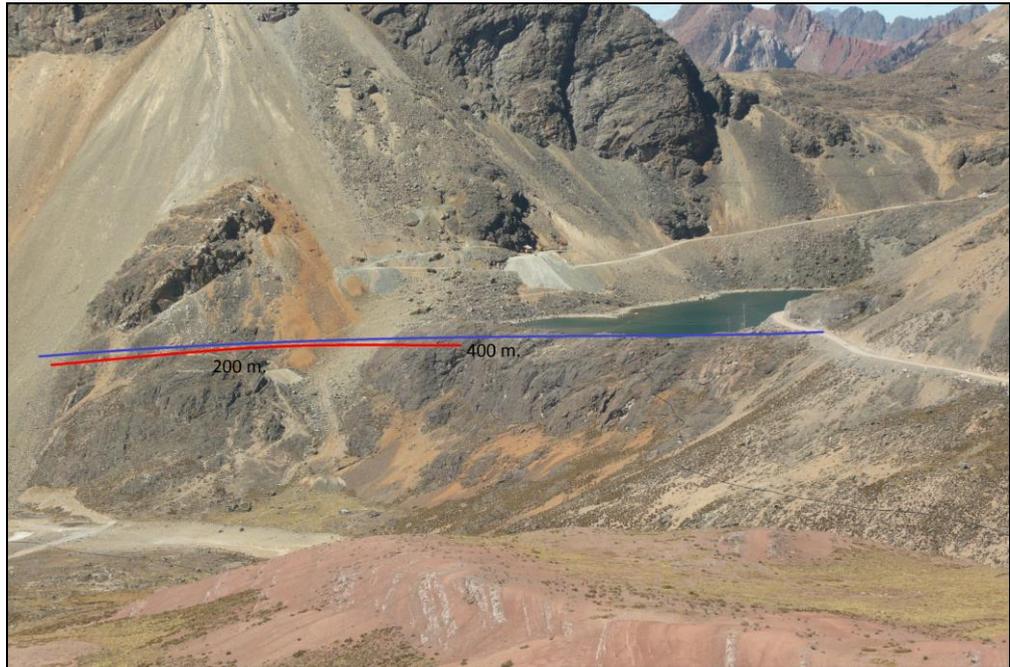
Tramo del canal de la margen derecha a construir, se construirá sobre la actual cantera de relleno del dique y que está a nivel de trocha.
